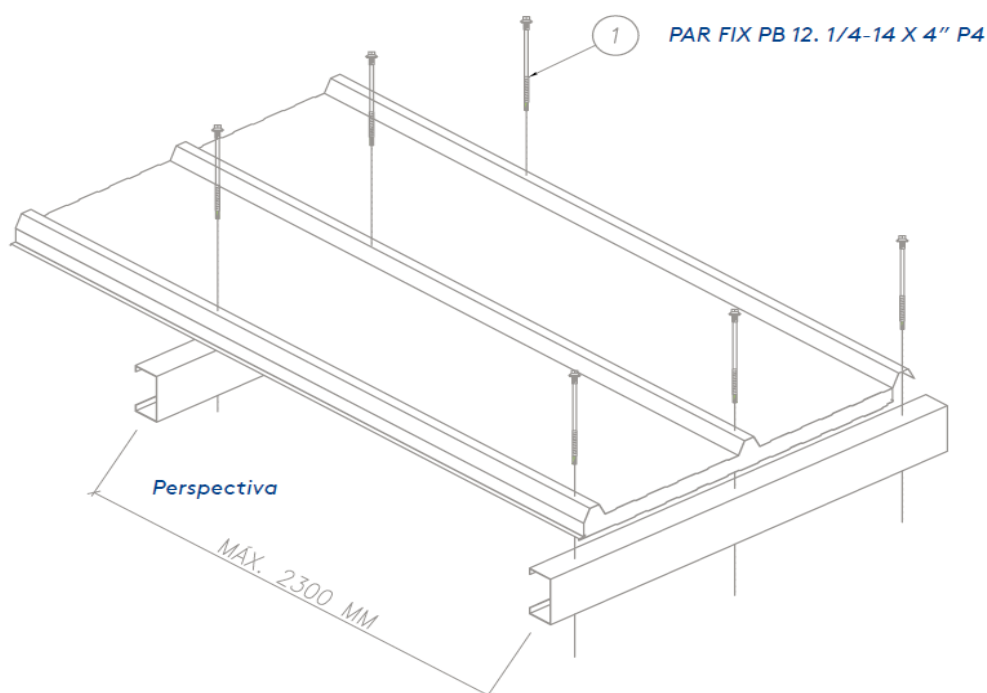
Fixação das telhas por aparafusamento, vista em perspectiva.
